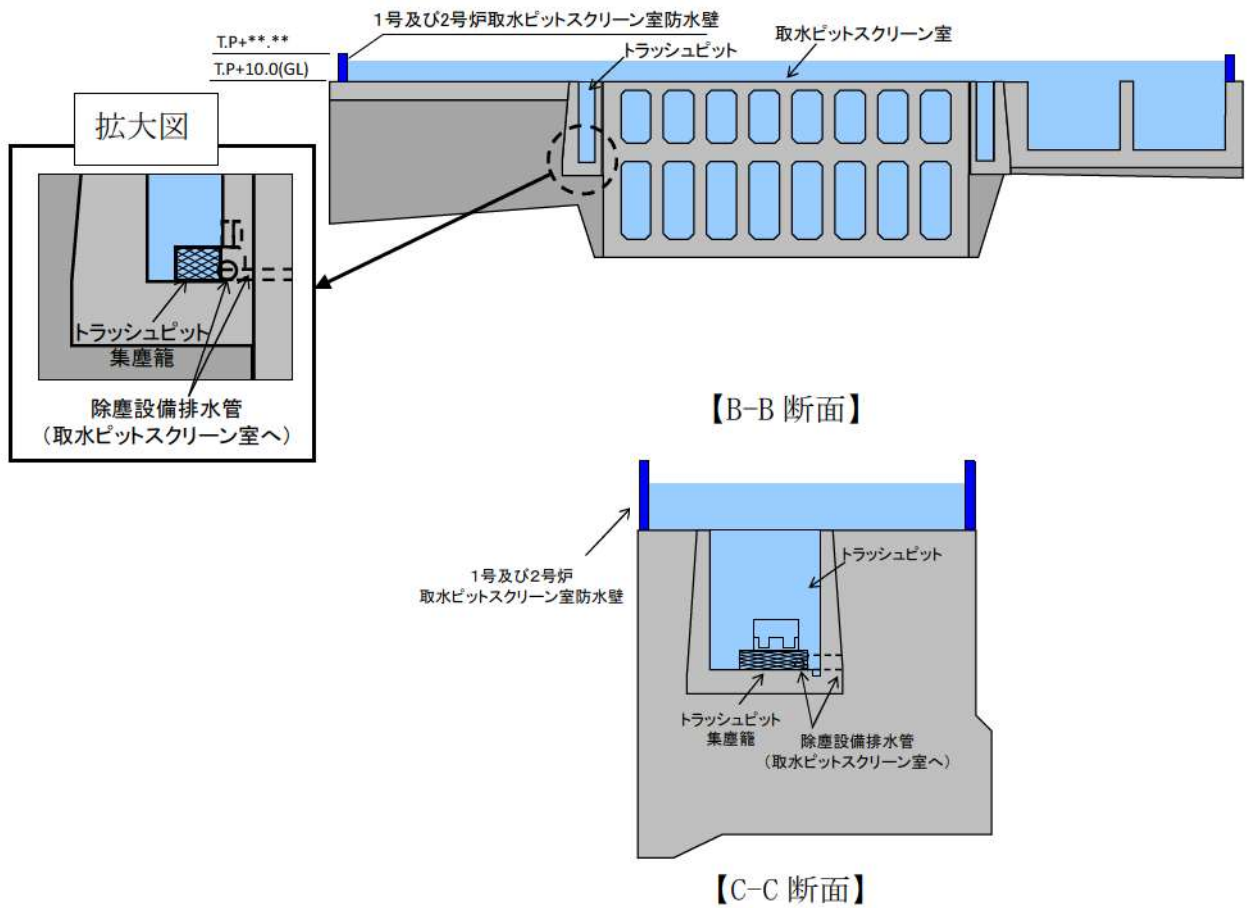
1号及び2号炉取水系統 流入対策配置図 (B-B, C-C 断面図)
